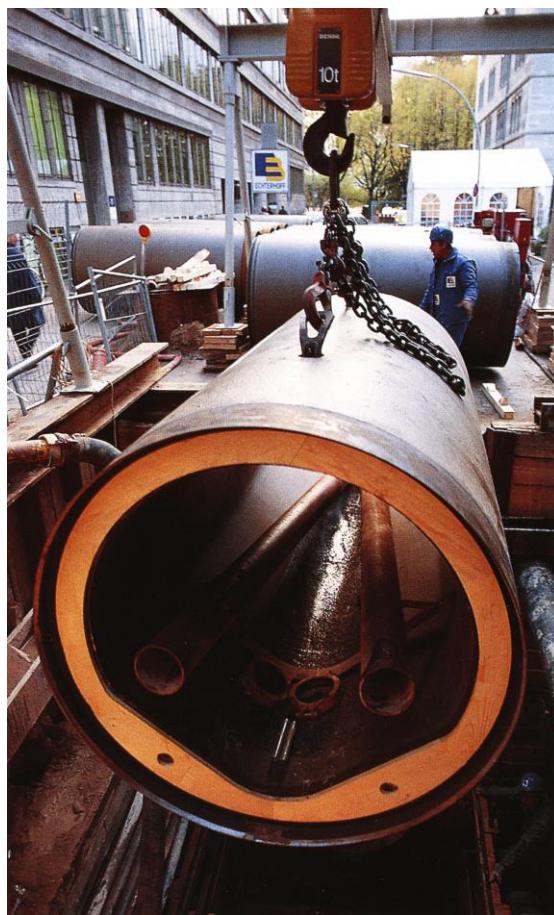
Труба из полимербетона со специальным профилем
